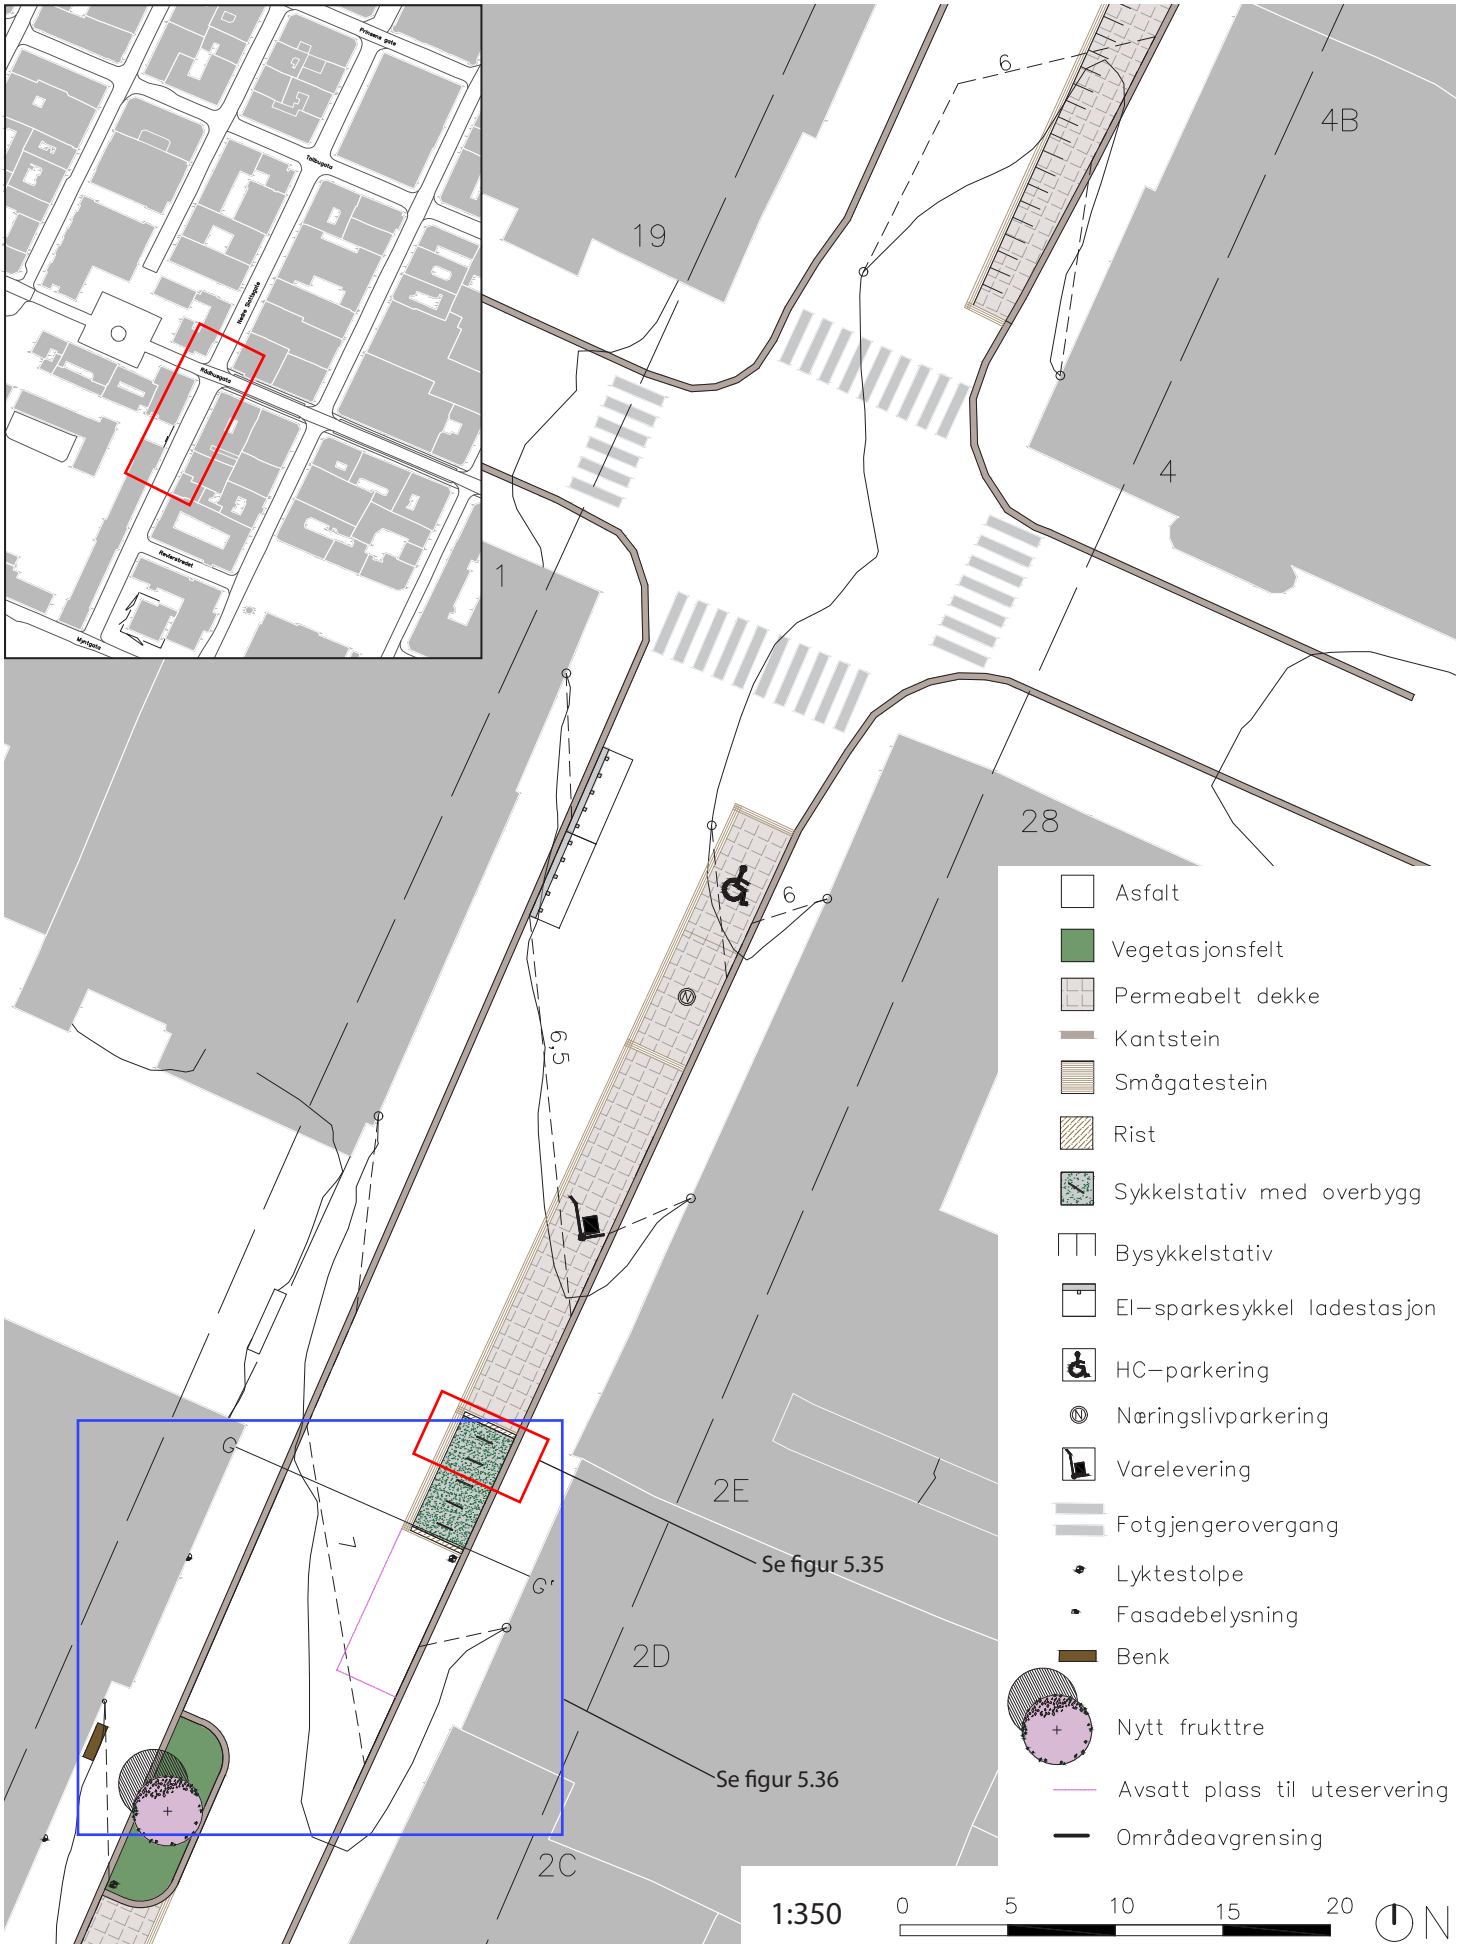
Detaljutsnitt fra plan. Klatreplantestativ med rist rundt.
